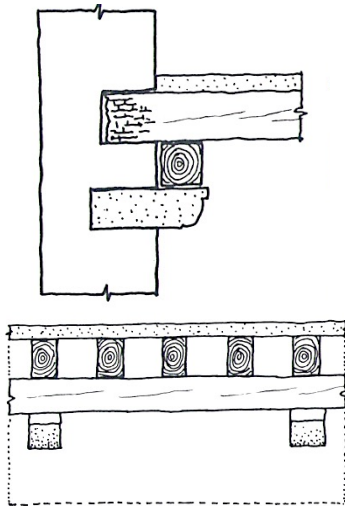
Apoio das extremidades das vigas. Solução com cachorros de madeira. Arriaga [1]
